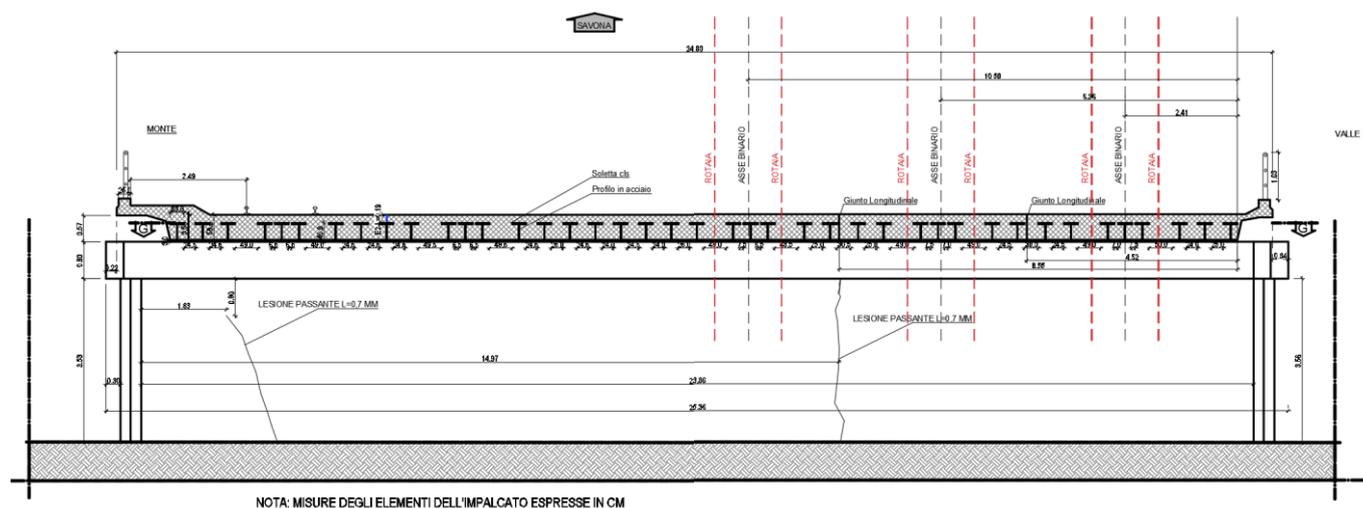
Ponte via Ferraris – individuazione posizione binari nuovi PRG
